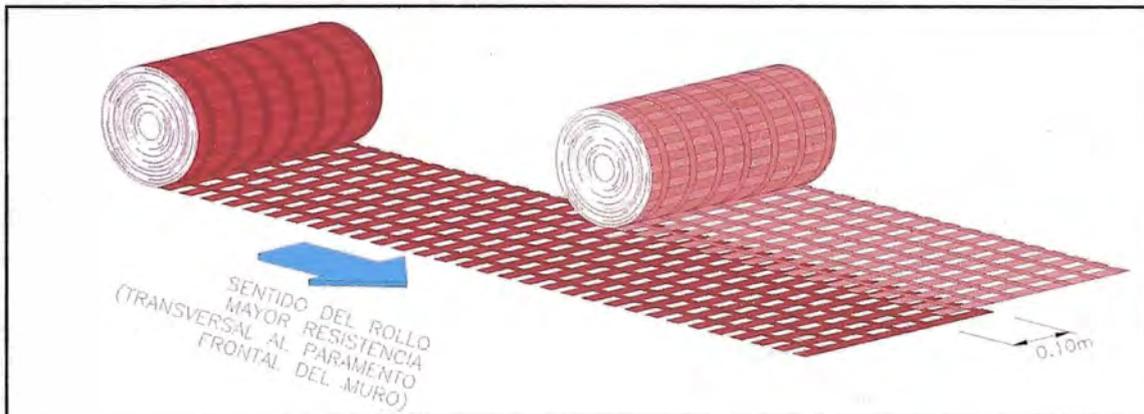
Muro de suelo reforzado – Detalle de traslape en Geomalla Mac-Grid.
